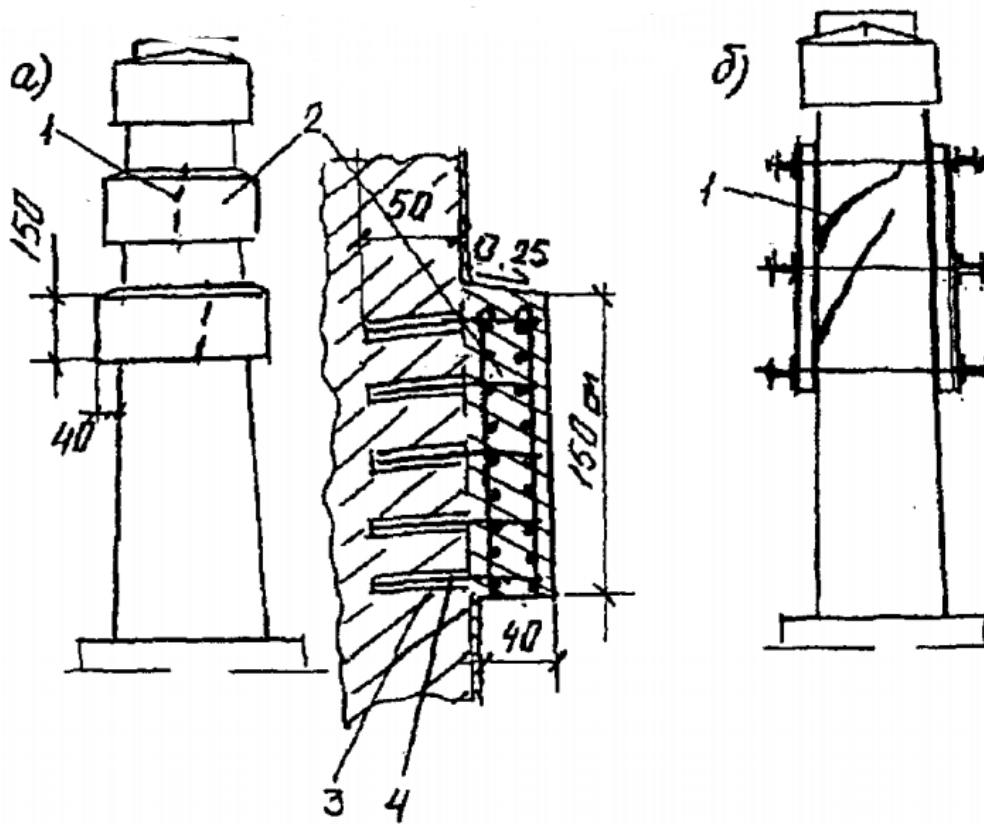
Железобетонные пояса и стальные бандажи опоры:
